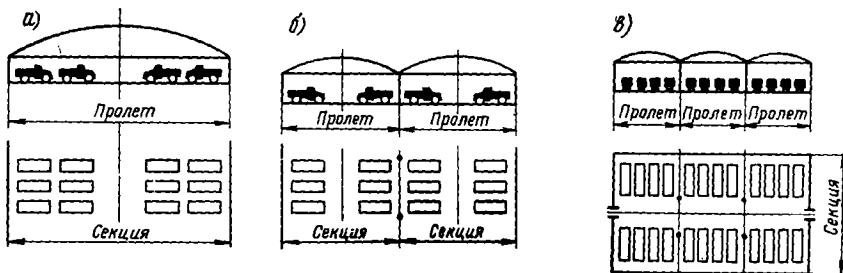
Сочетание планировочных секций с пролетами зданий:
